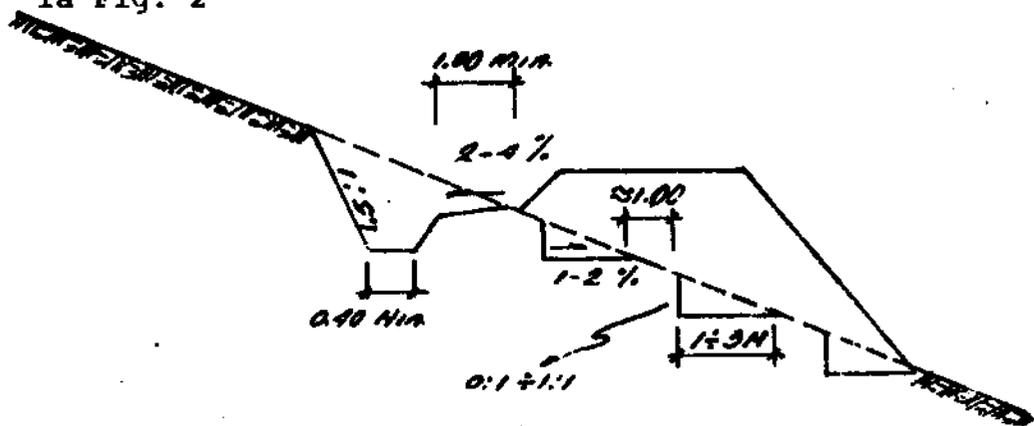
Sección transversal típica de terraplén hasta 12 m de altura, para pendientes transversales del terreno mayor del 30%
